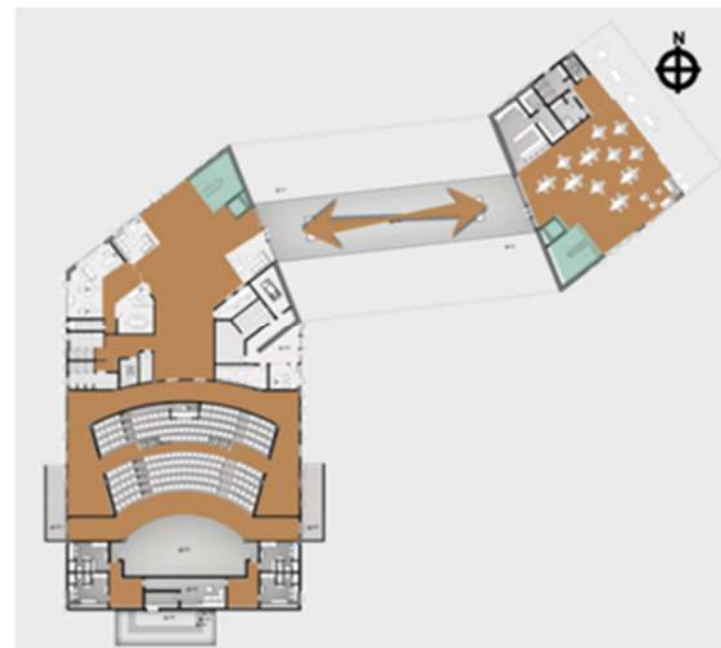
Plantas Baja Circulación Horizontal y Vertical
